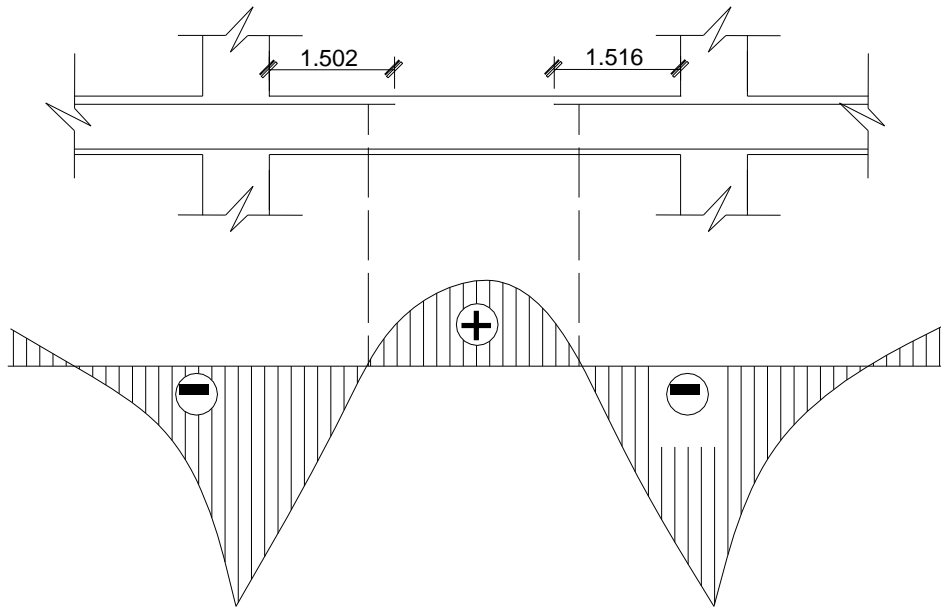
Longitud de las varillas de acero de refuerzo en una estructura de concreto
